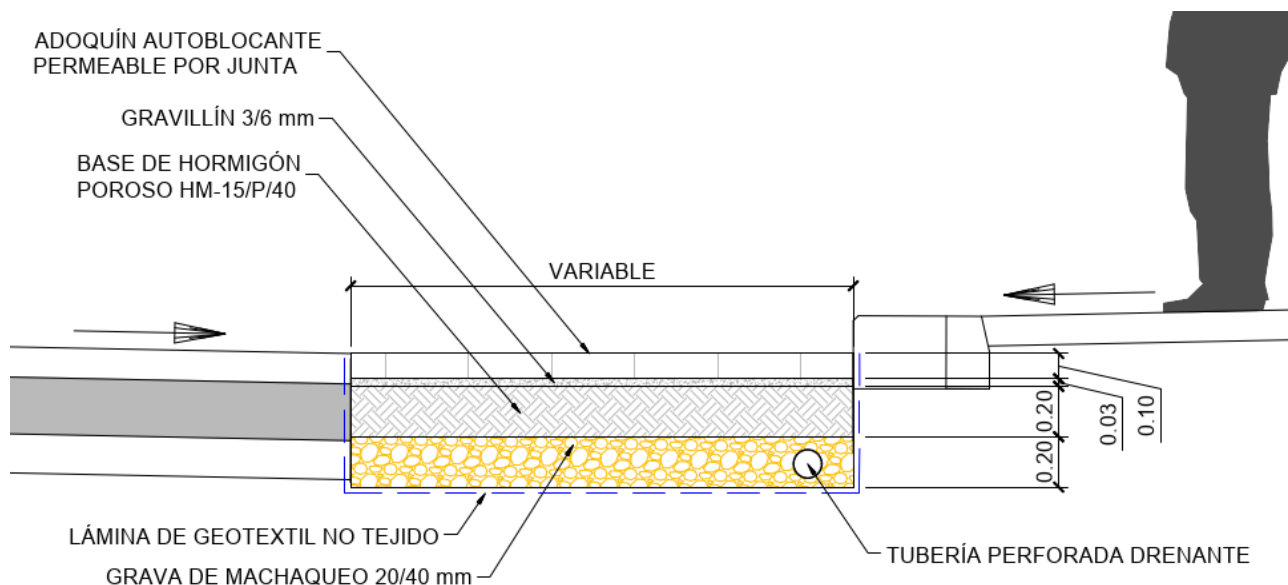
Sección transversal ejemplo para los pavimentos permeables.
